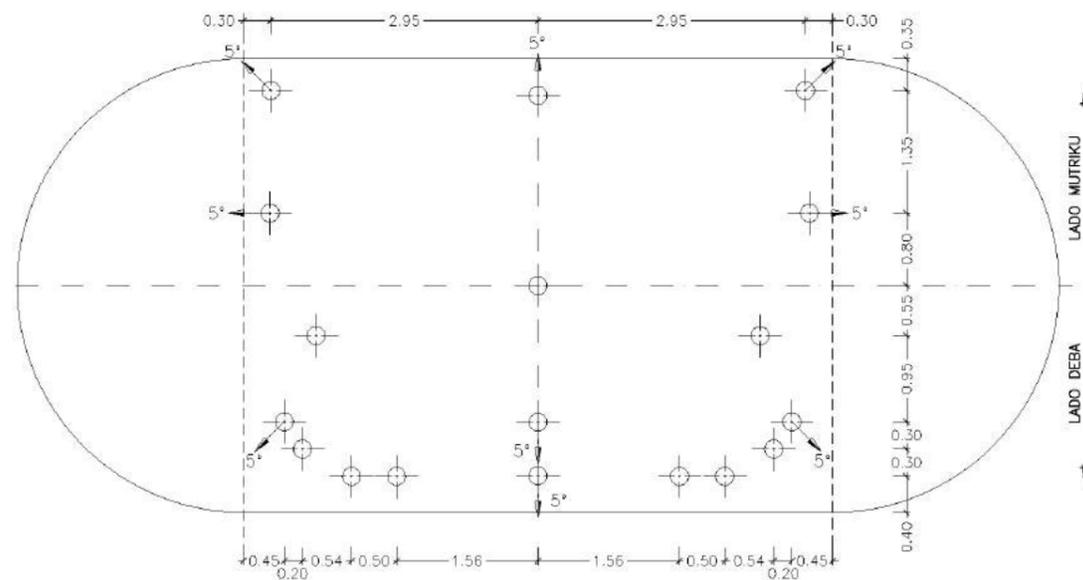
Recalce planteado y realizado durante la obra de emergencia, en pila 3
